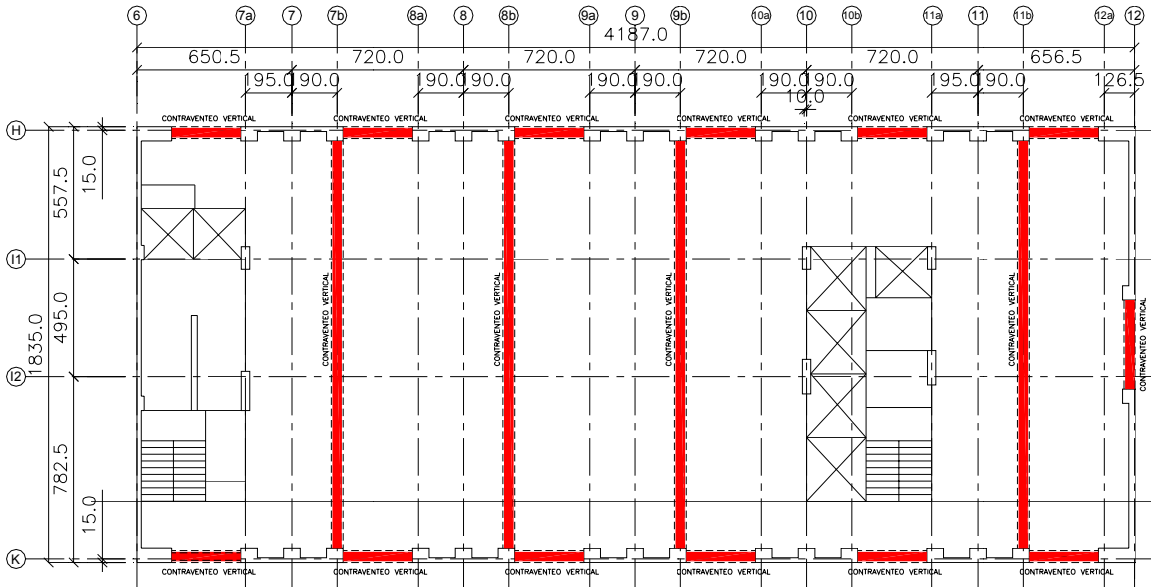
Vista en planta de la localización del nuevo refuerzo vertical, con diagonales en la Torre Mayor
